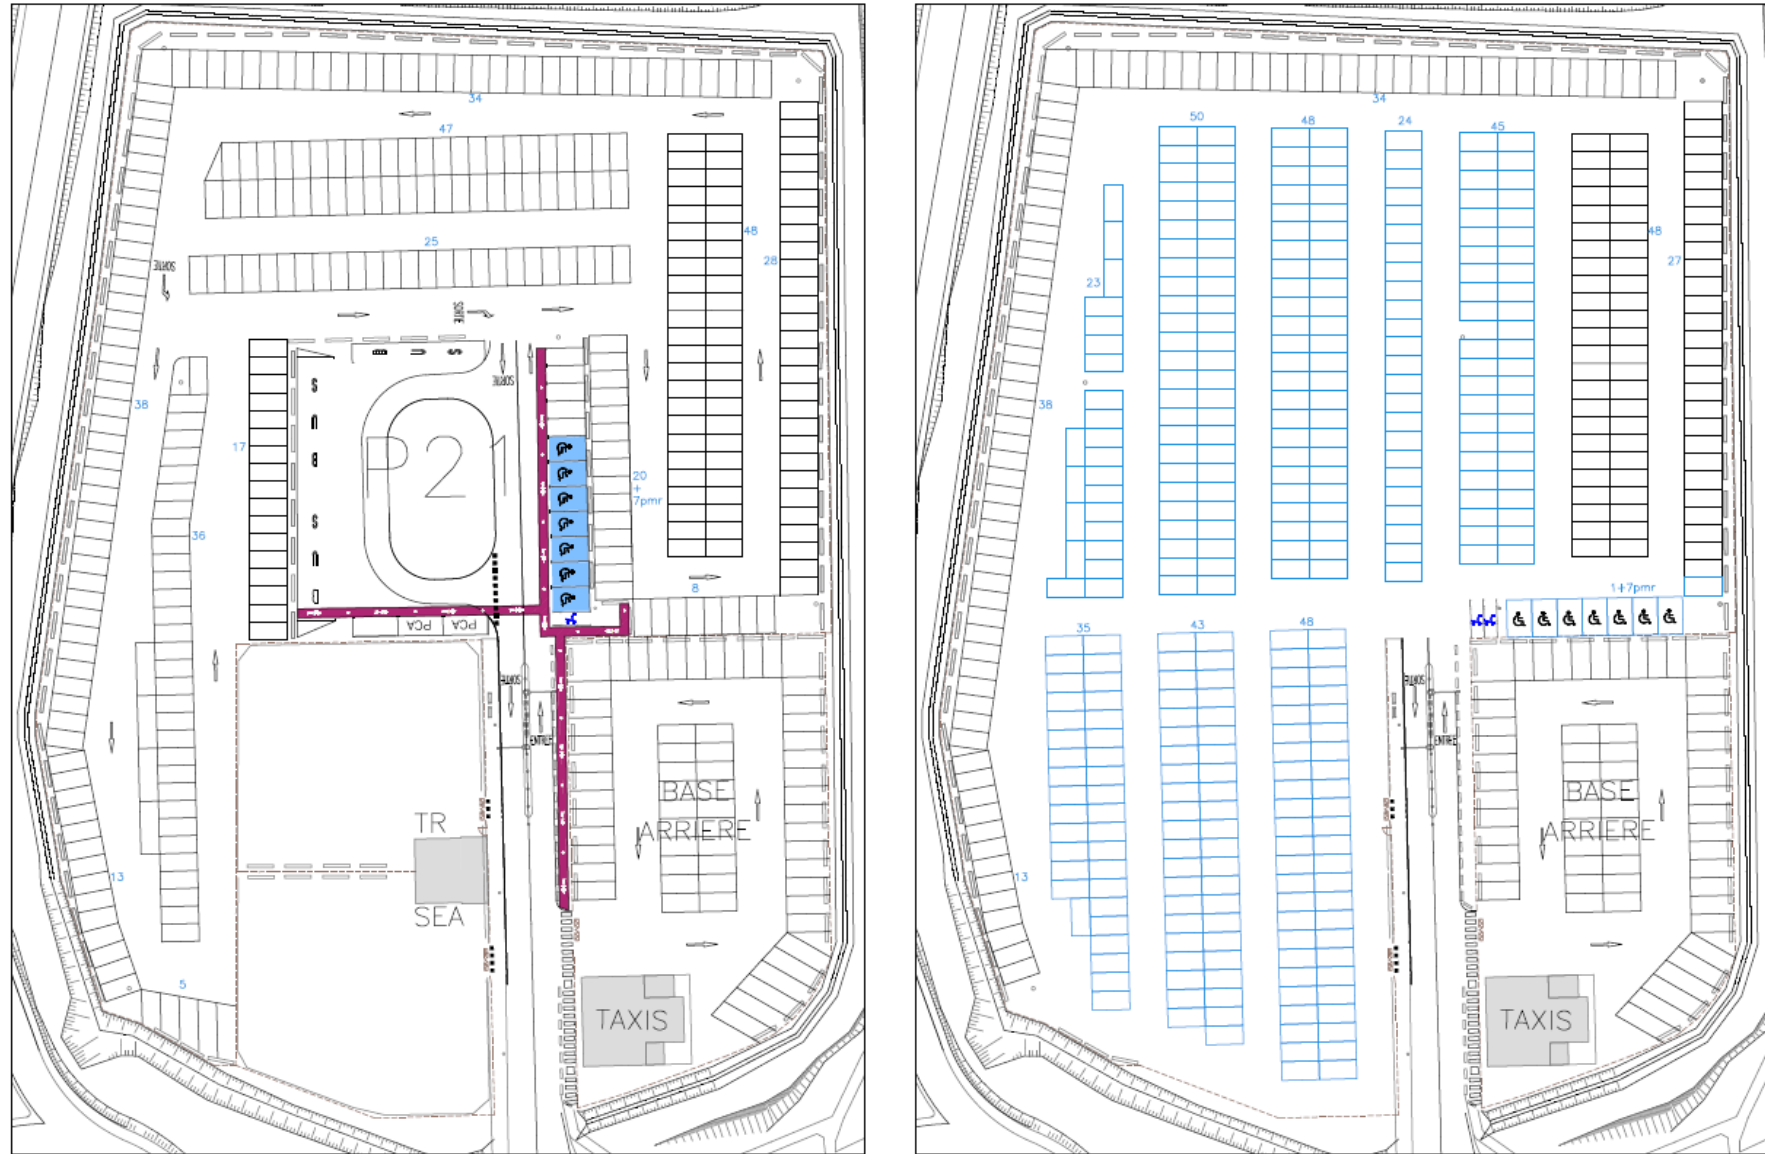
Plan du parking P21, existant et en projet (source : AMP)
